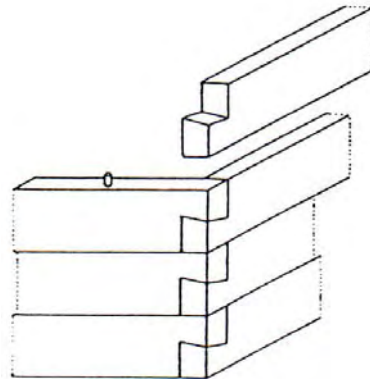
Verzinkte Wandecken beschnittener bzw. behauener Fachwerkwände
